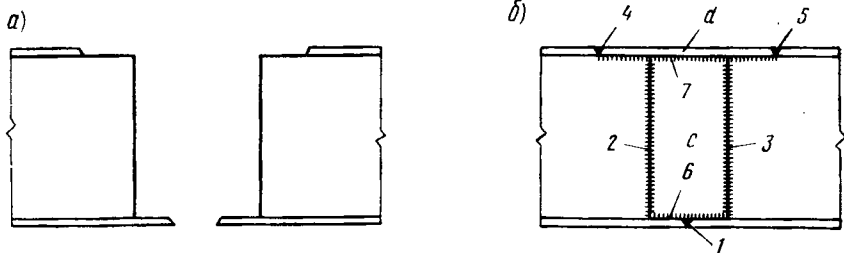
Сварной монтажный стык стенок пролетных строений:
